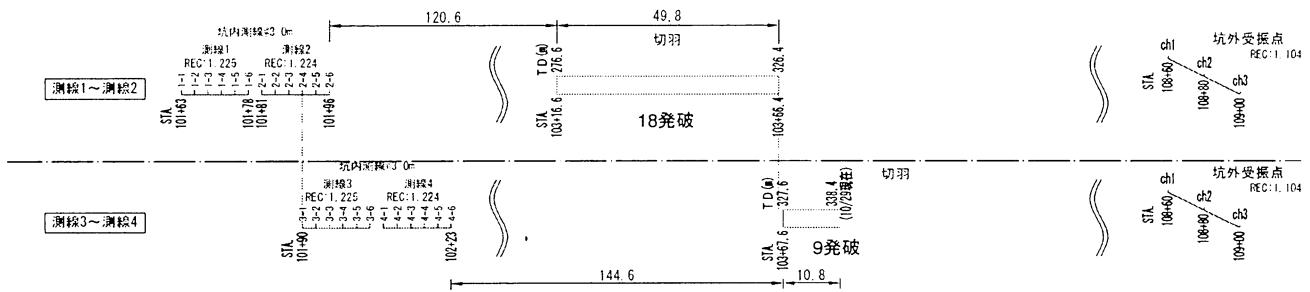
連続SSRT探査機器の平面配置と掘削発破位置
